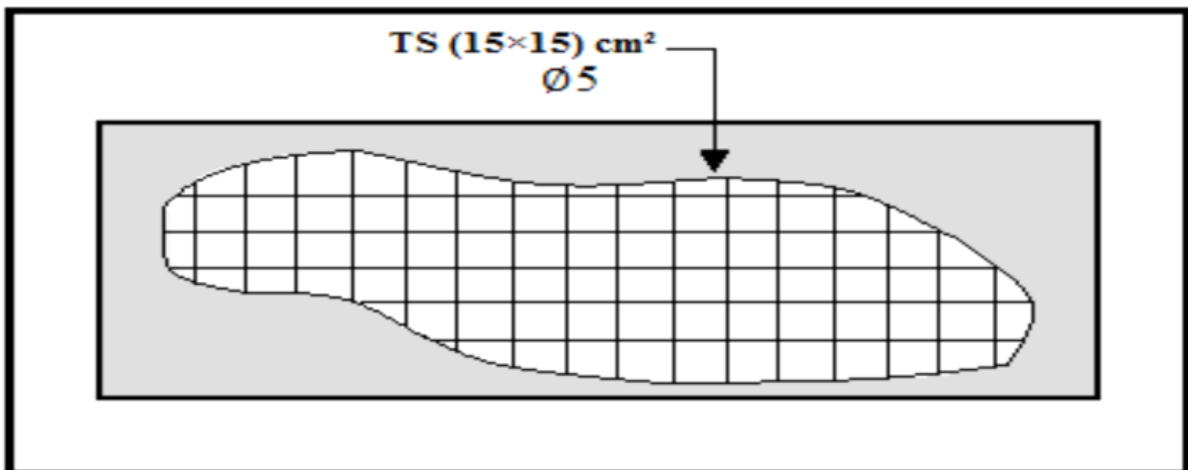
Schéma de ferrailage de la dalle de compression.[5]
